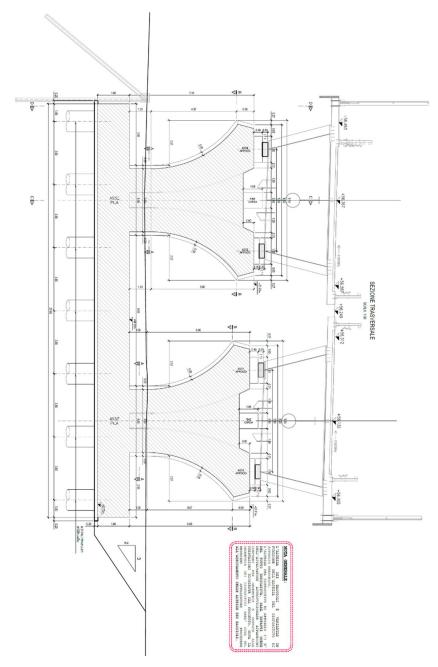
Sezione Tipica Trasversale Pila (P3).
